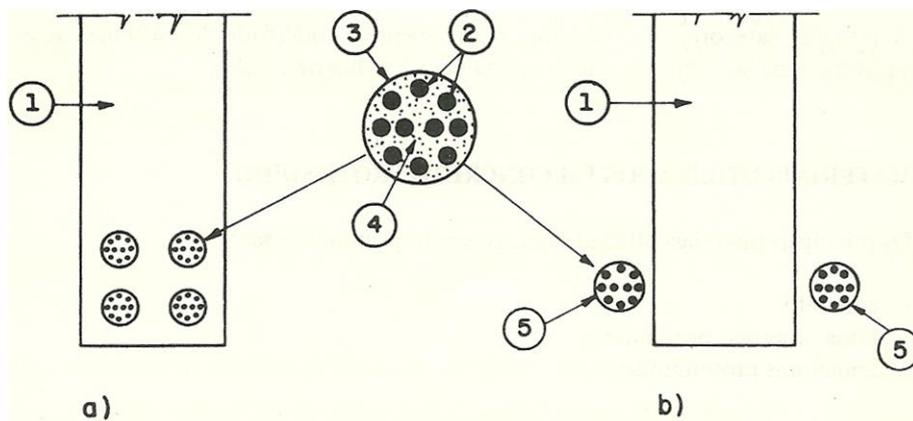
Armaduras pós-tracionadas, aderentes ao concreto.
